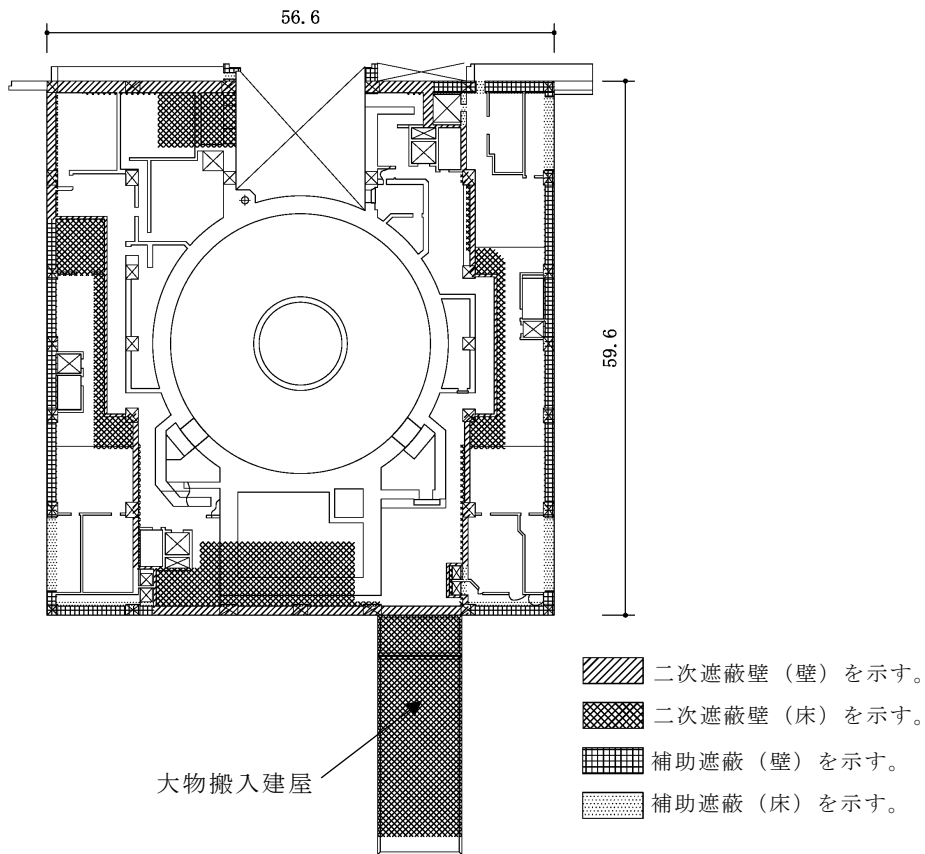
二次遮蔽壁及び補助遮蔽の範囲の平面図
